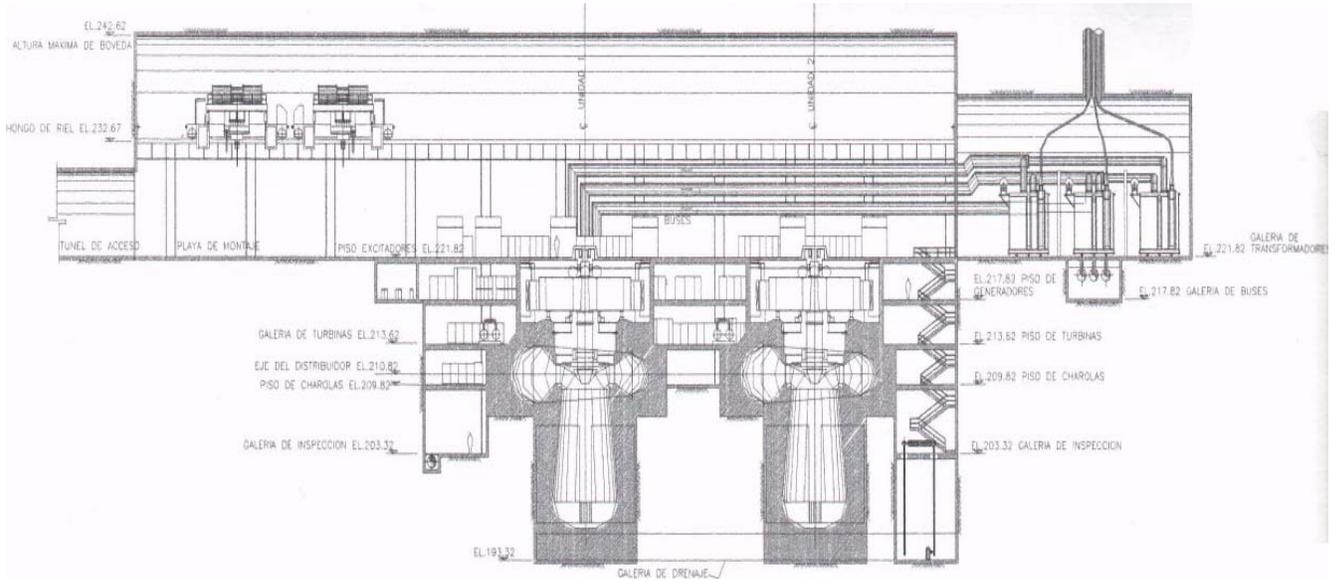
Túnel de acceso a casa de máquinas (corte longitudinal)
